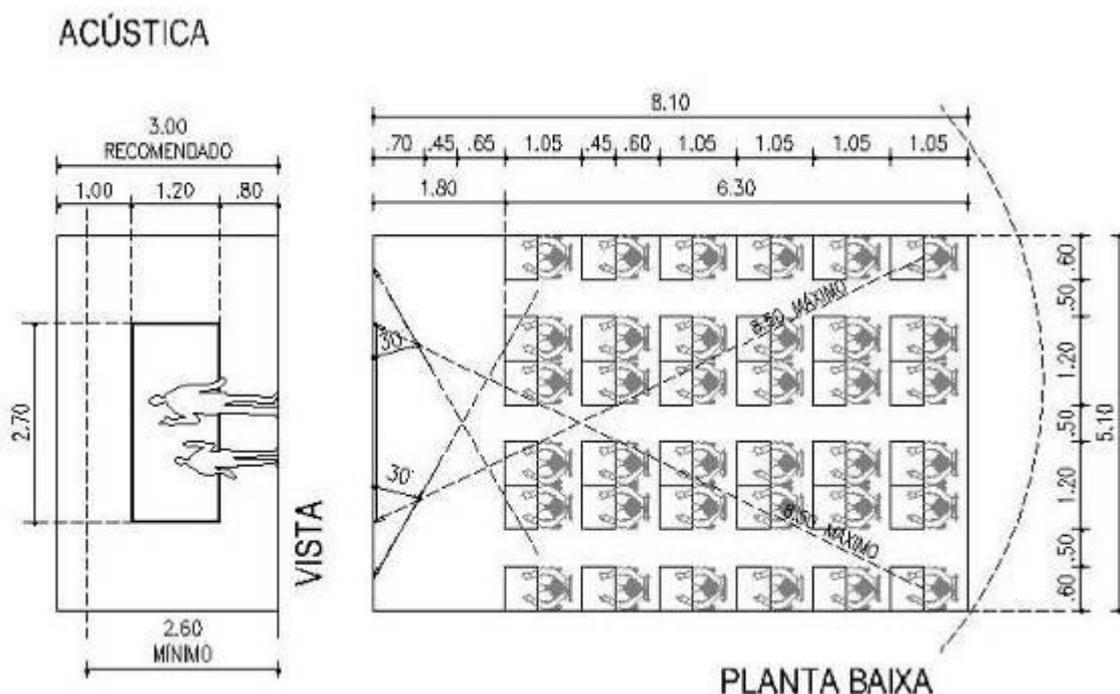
Planta de acústica. Fonte: Cortez e Braga (2002).
